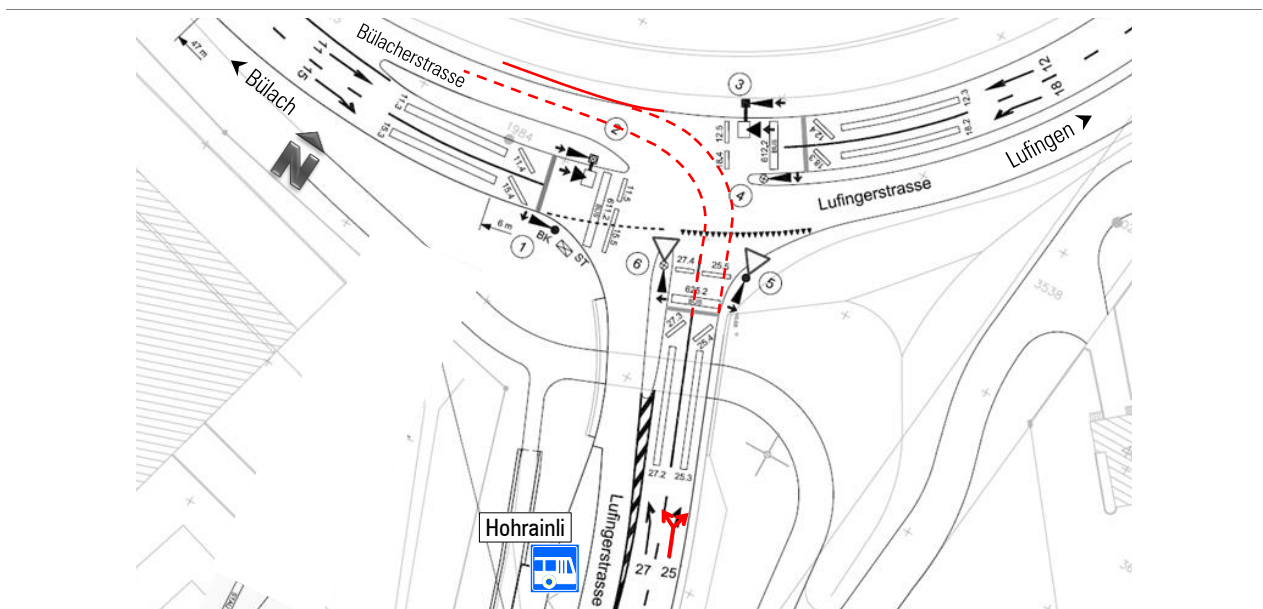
Ausschnitt Signallageplan LSA Nr. 193, Lufinger-/ Bülacherstrasse mit Änderung Fahrstreifen-Zuordnung
